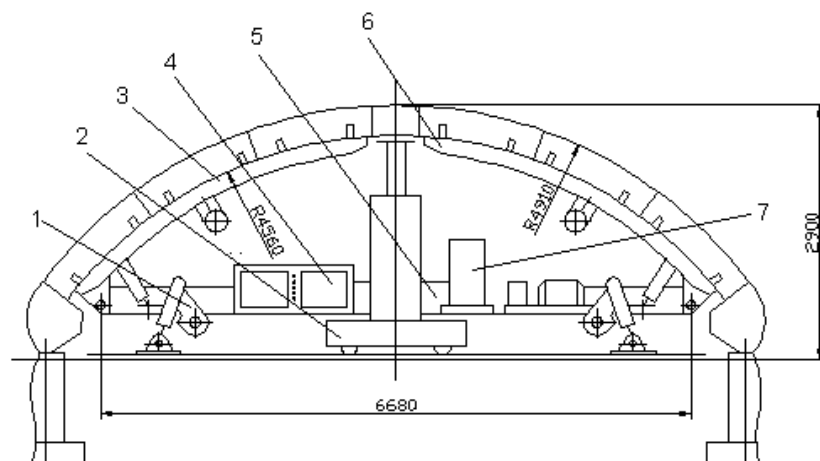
Схема агрегату для вкладання верхнього склепіння:
